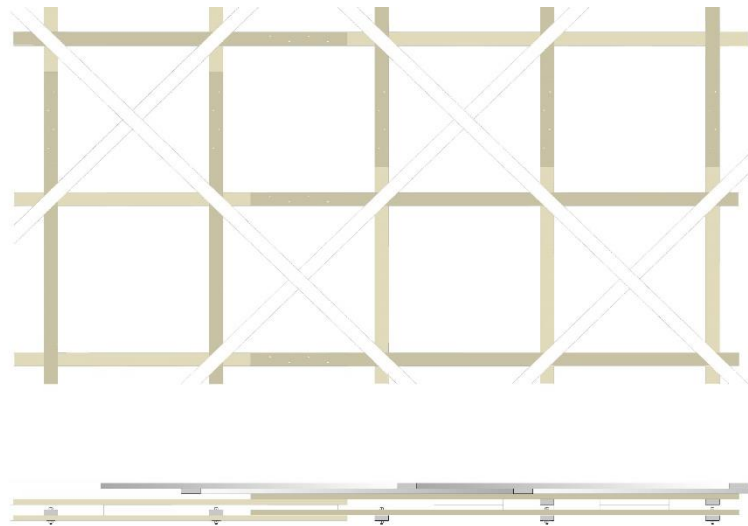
vista in pianta e sezione della maglia assemblata, in bianco gli elementi diagonali
